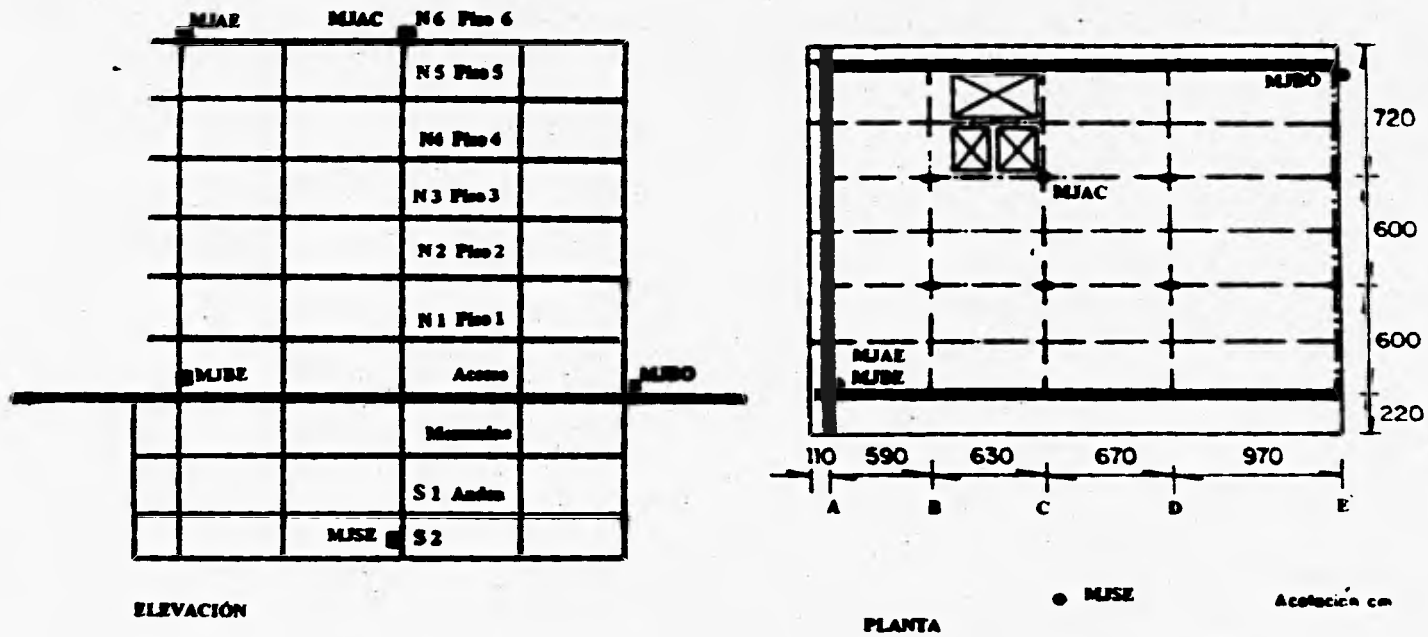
Elevación y Planta del Edificio Metro Juárez. (En los puntos se indica la ubicación y la clave de los acelerógrafos).
